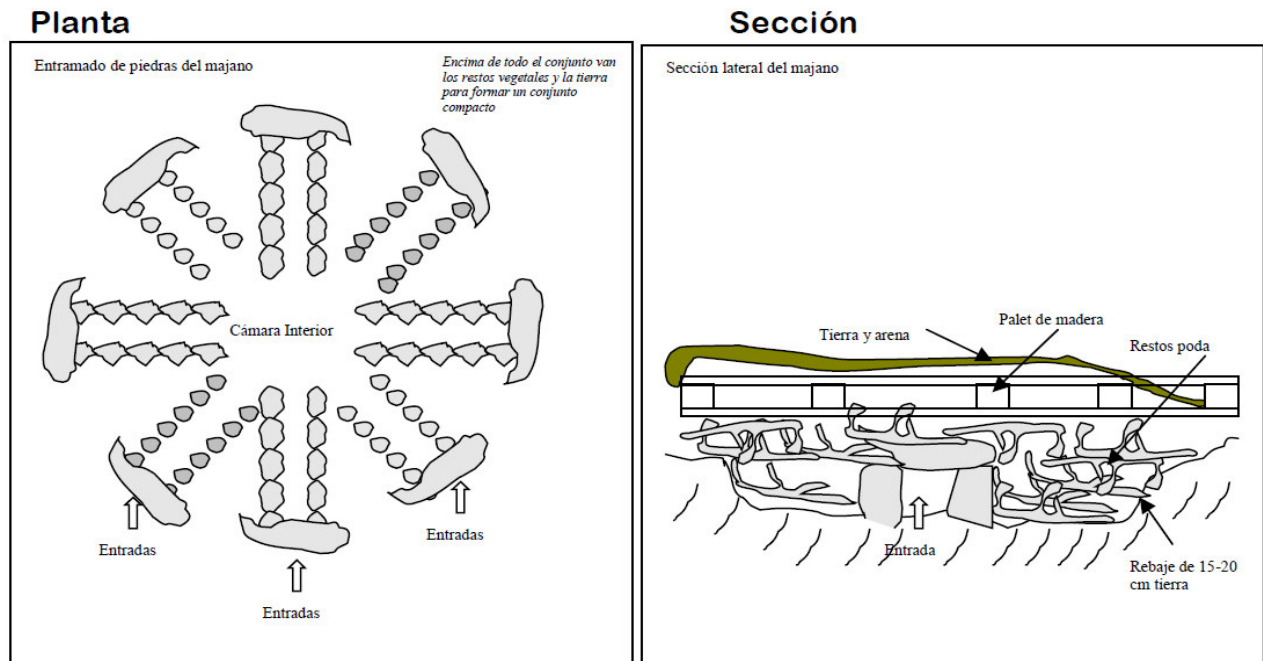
Planta y sección de un majano que combina piedra y pallet de madera.
